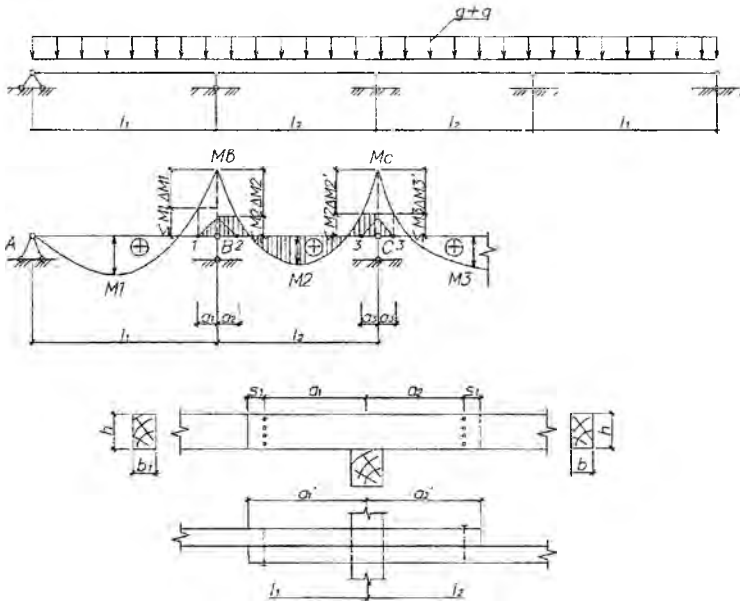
Неразрезной прогон: расчетная схема (а); эпюра изгибающих моментов (б); стыкование прогона на опоре (в)
